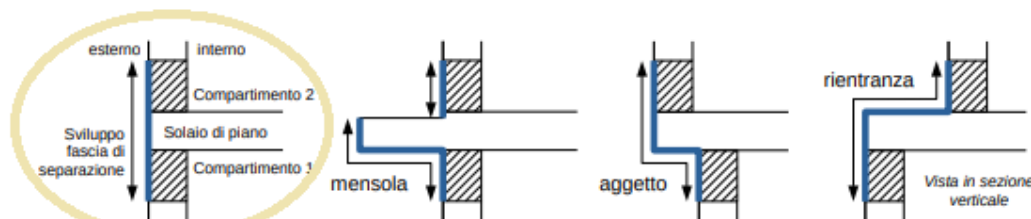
Esempi di fascia di separazione orizzontale in facciata
